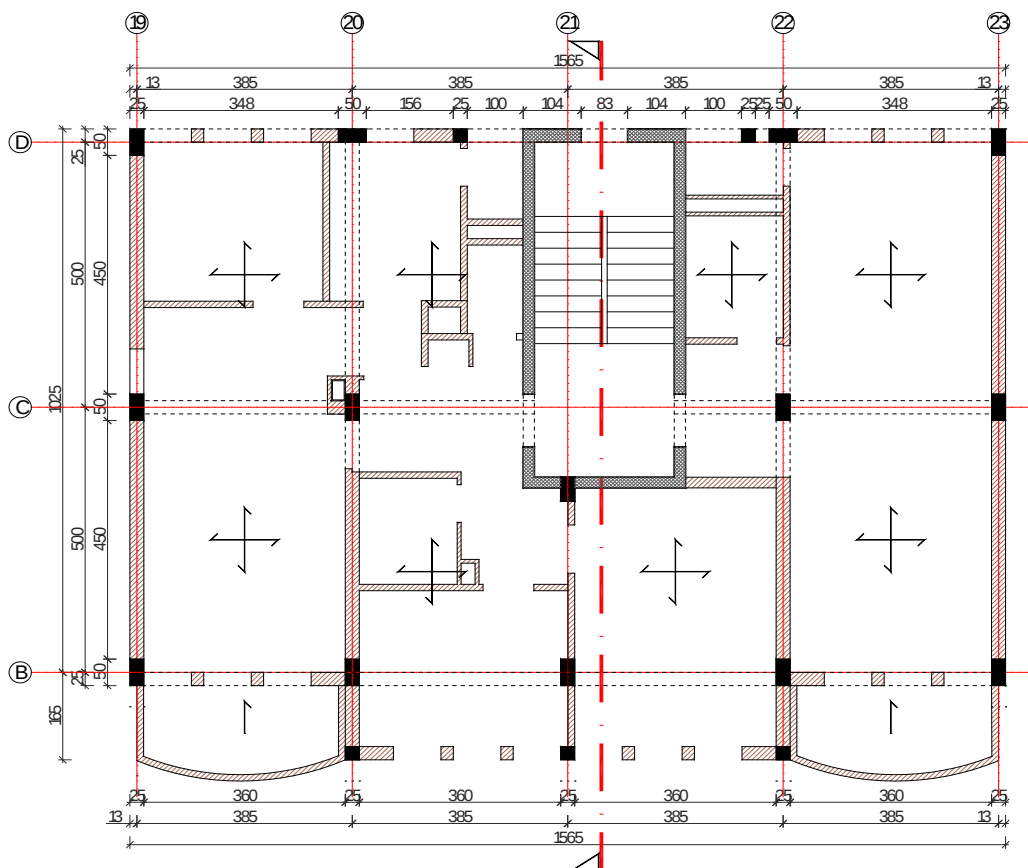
Planimetria e katit karakteristik të ndërtesës Z4, RC1H – Ram BA
